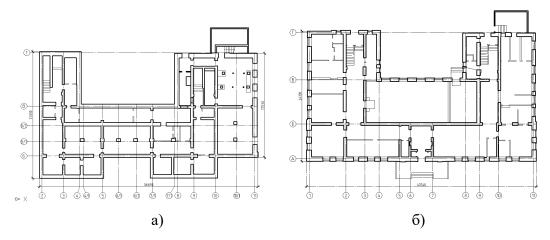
Типовой план подвала (а) и план первого этажа (б) зданий школ
